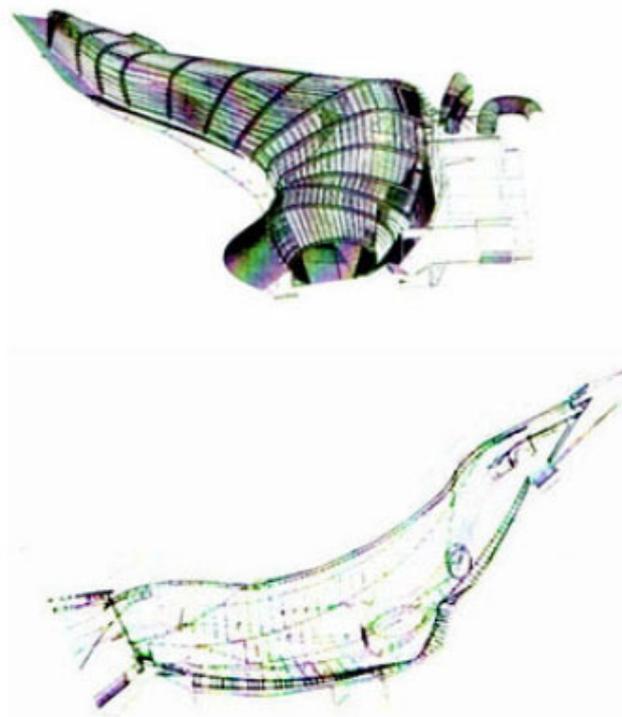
Perspectiva e planta do Fresh Water Pavillion.
